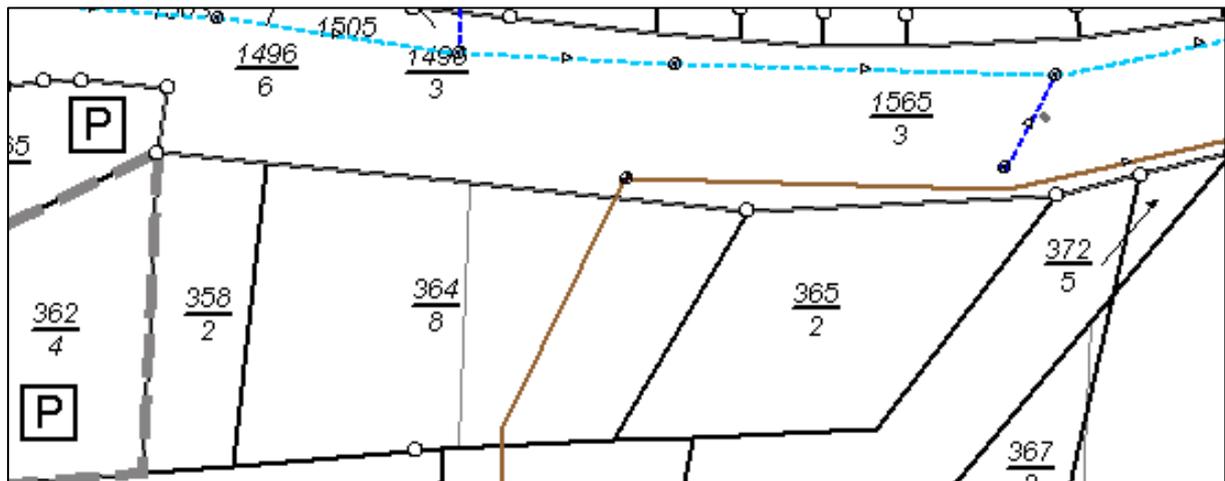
Kanalsystem im Bereich des Bebauungsplans
